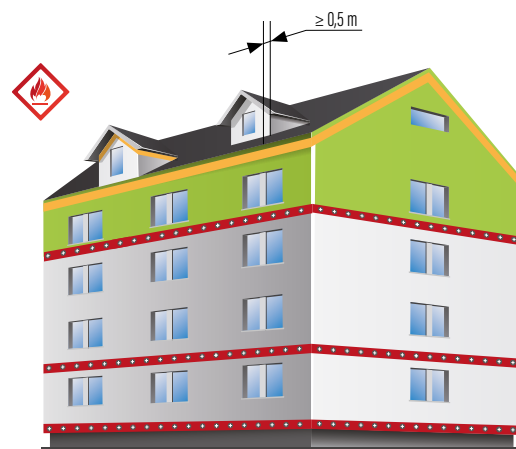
Ausführung von Abschlussriegeln unterhalb eines „ausgebauten“, brennbaren Steildaches mit Aufenthaltsräumen und Dachgauben, die mit EPS-WDVS gedämmt sind.
